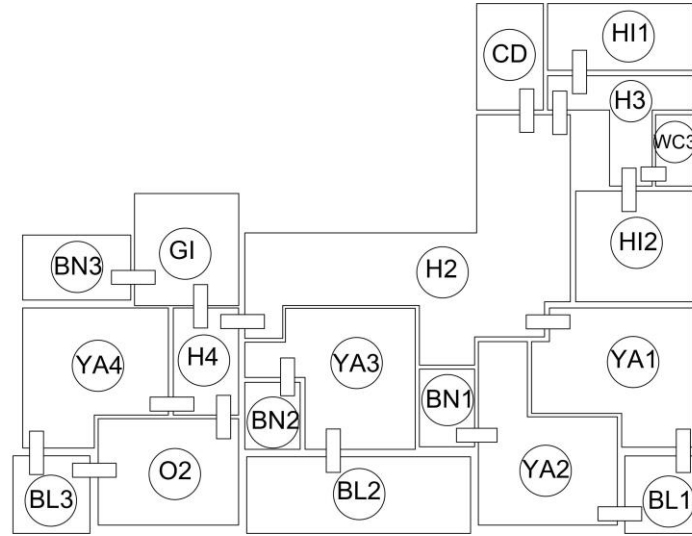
Uşaklıgil Köşkü giriş kat planı
